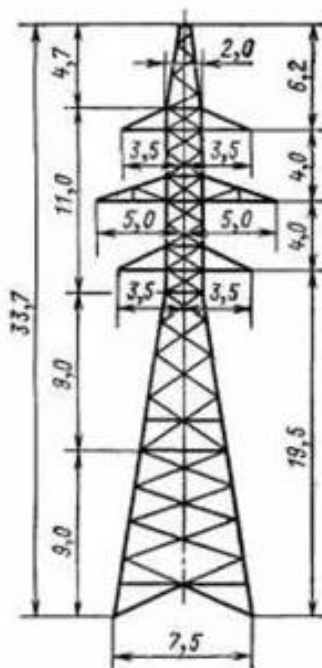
Схема анкерно-угловой опоры УБ 35-110-11 (14,5)
